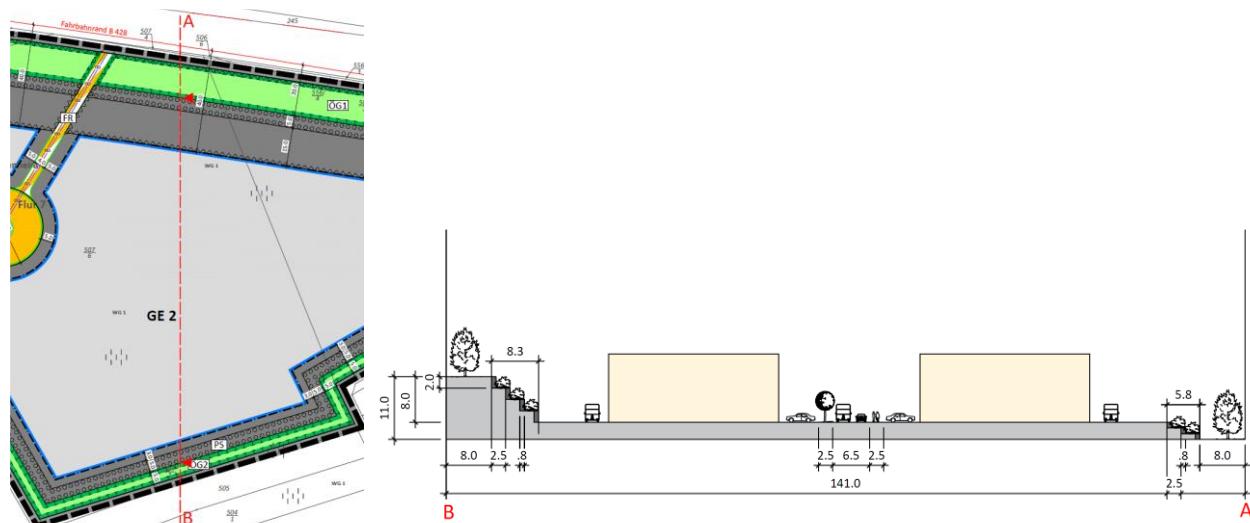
Geländeschnitt durch das Plangebiet zur Verdeutlichung der getroffenen Festsetzung
